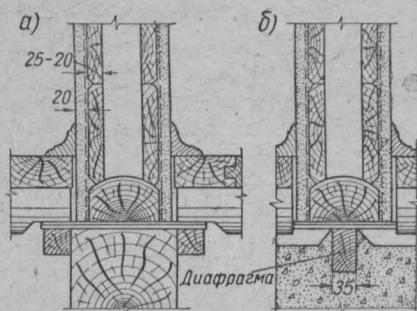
Схема сопряжения каркасно-обшивной перегородки с перекрытиями.
